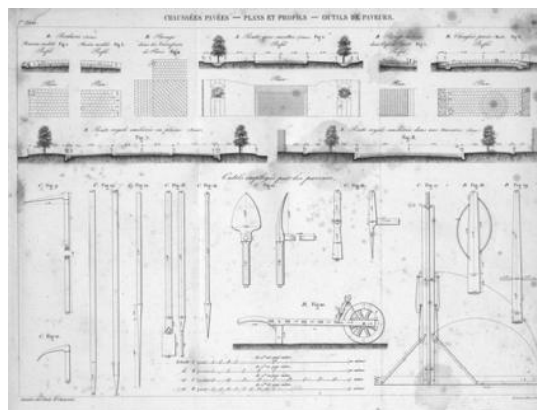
> Estudio de las secciones y plantas de pavimentos empleados en Seine, París, Oxford Street y "Nord" (Administration des Ponts et Chaussées 1841, p.402)
